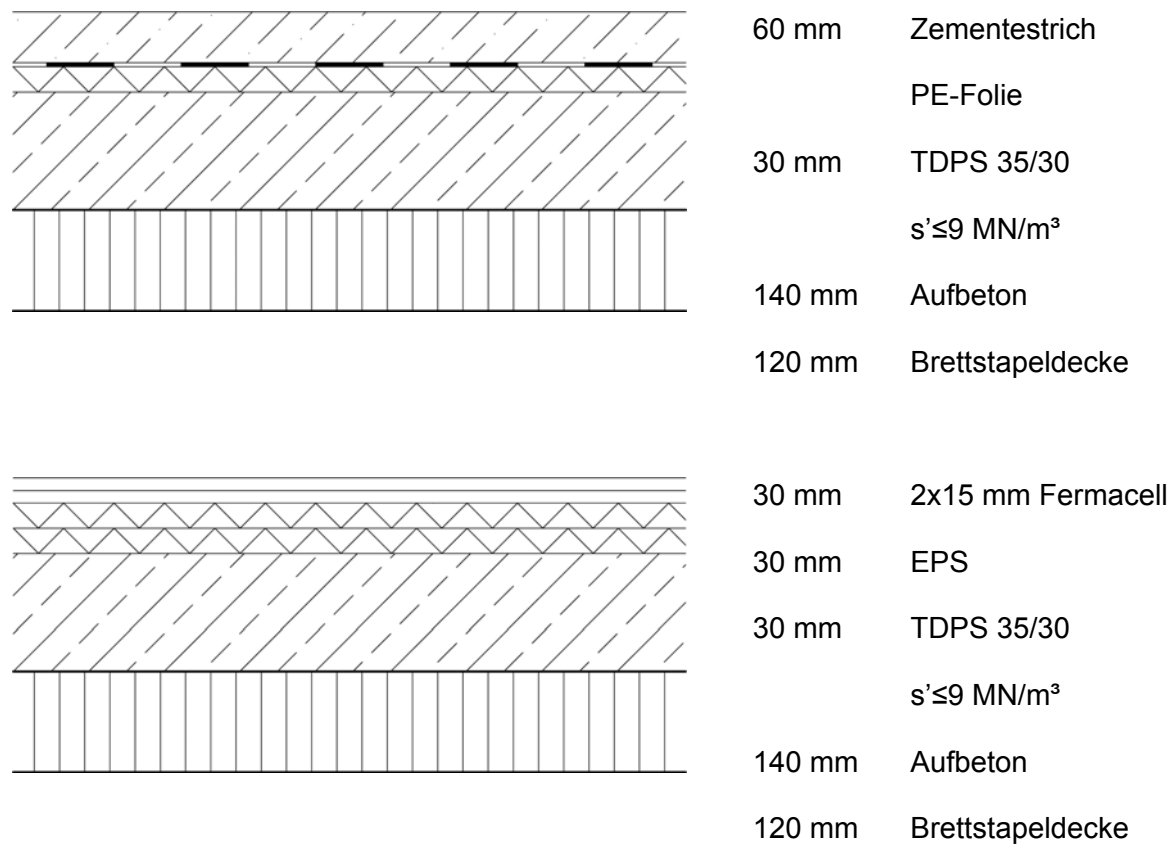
gemessene Aufbauten – Holz-Beton-Verbunddecke
